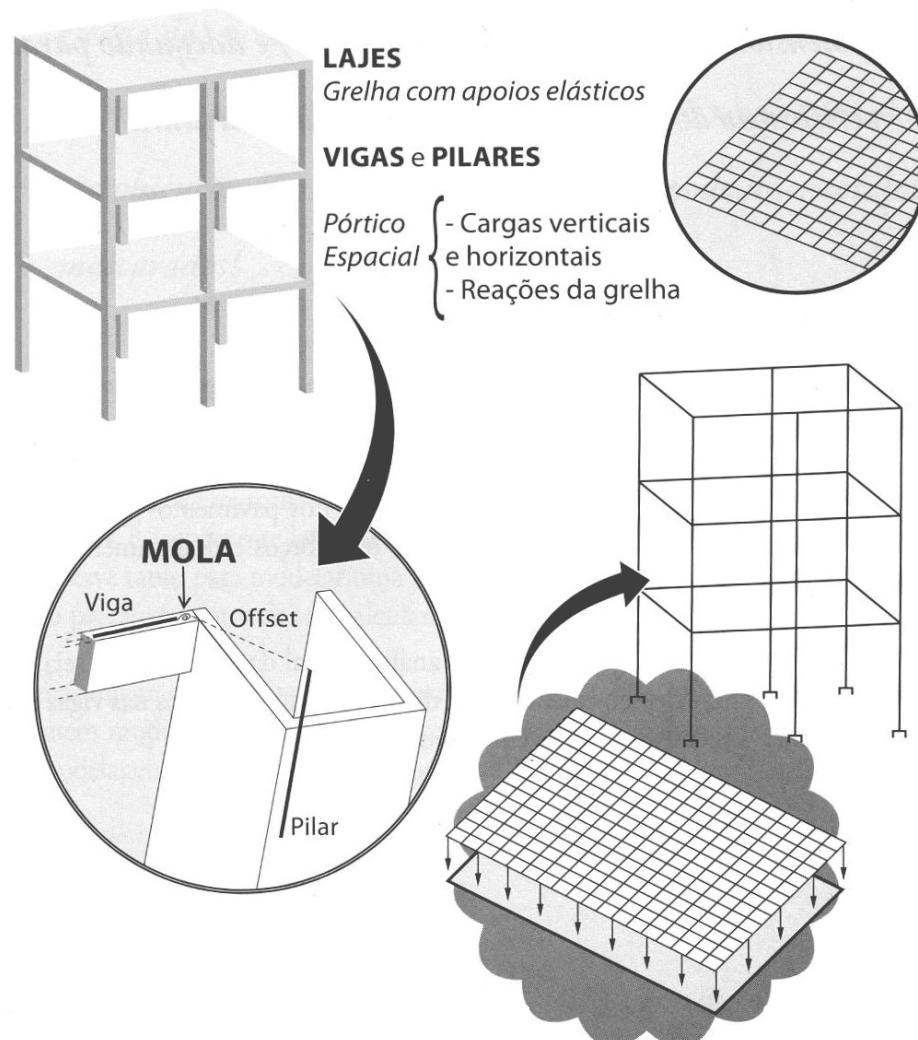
Modelo atual de cálculo de edifícios de Concreto Armado (KIMURA,2007).
